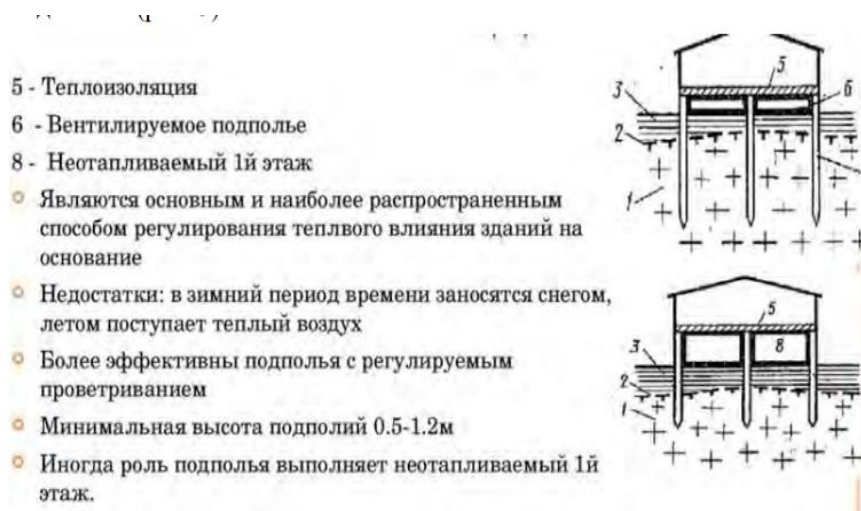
Приподнятая плита перекрытия над поверхностью грунта
